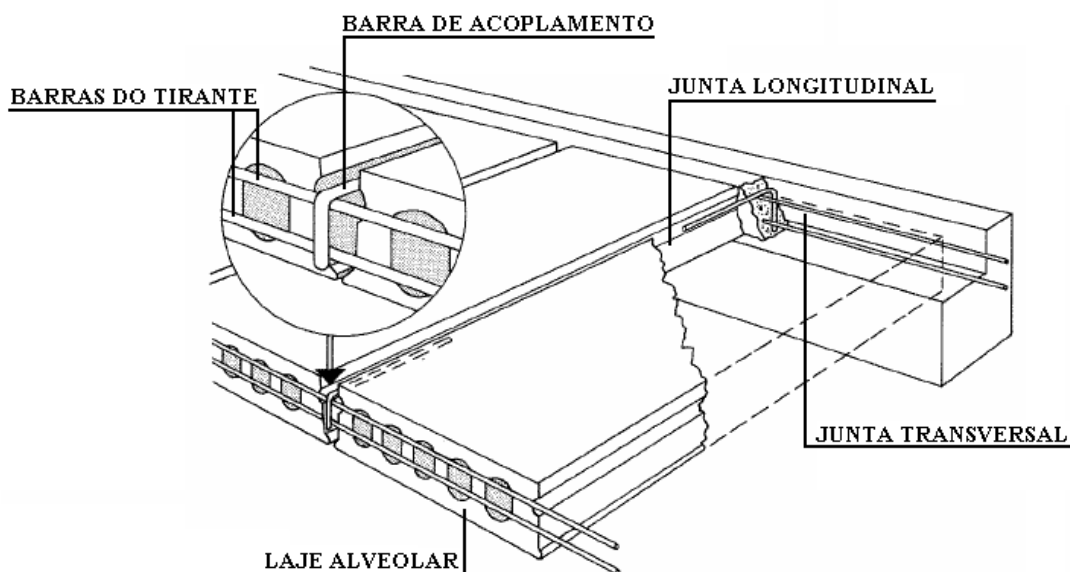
Exemplo de inserção das armaduras de reforço nas juntas entre lajes (BASEADO EM: FIB, 2008).
